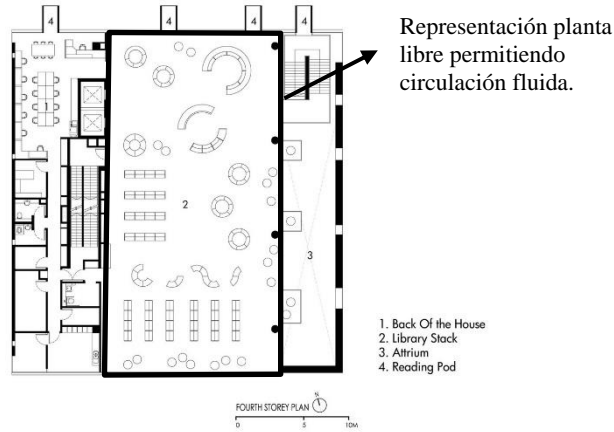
Planta primer nivel Biblioteca. LOOK Architecs (2006)
